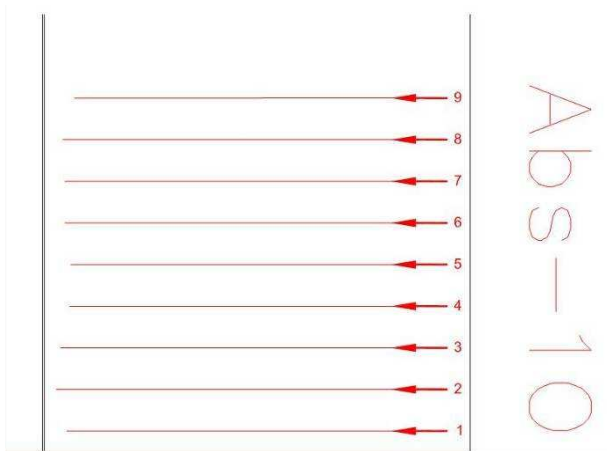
Localizzazione e schematizzazione profilo Abs-10
